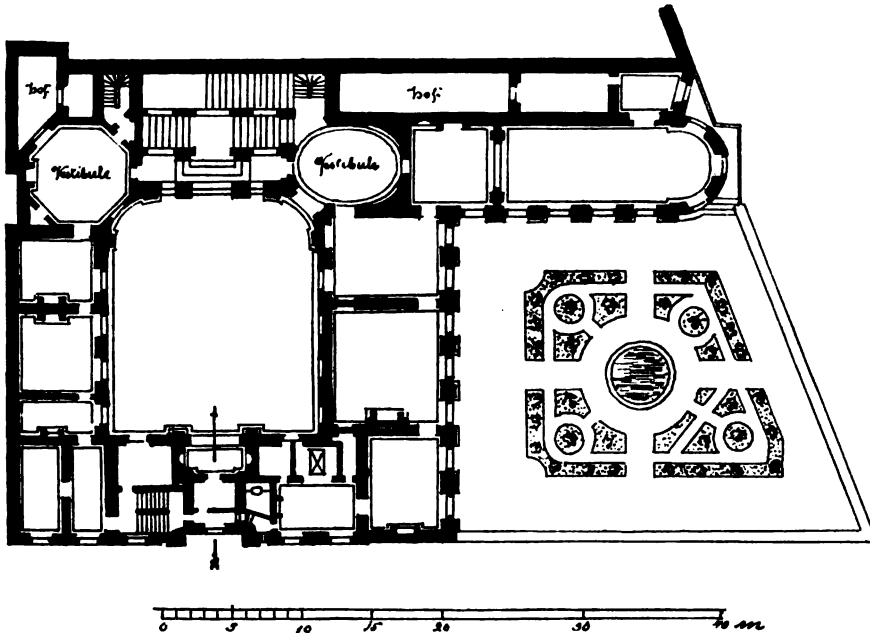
Hôtel Lambert. Grundriss I. Etage (n. Sauvageot).
